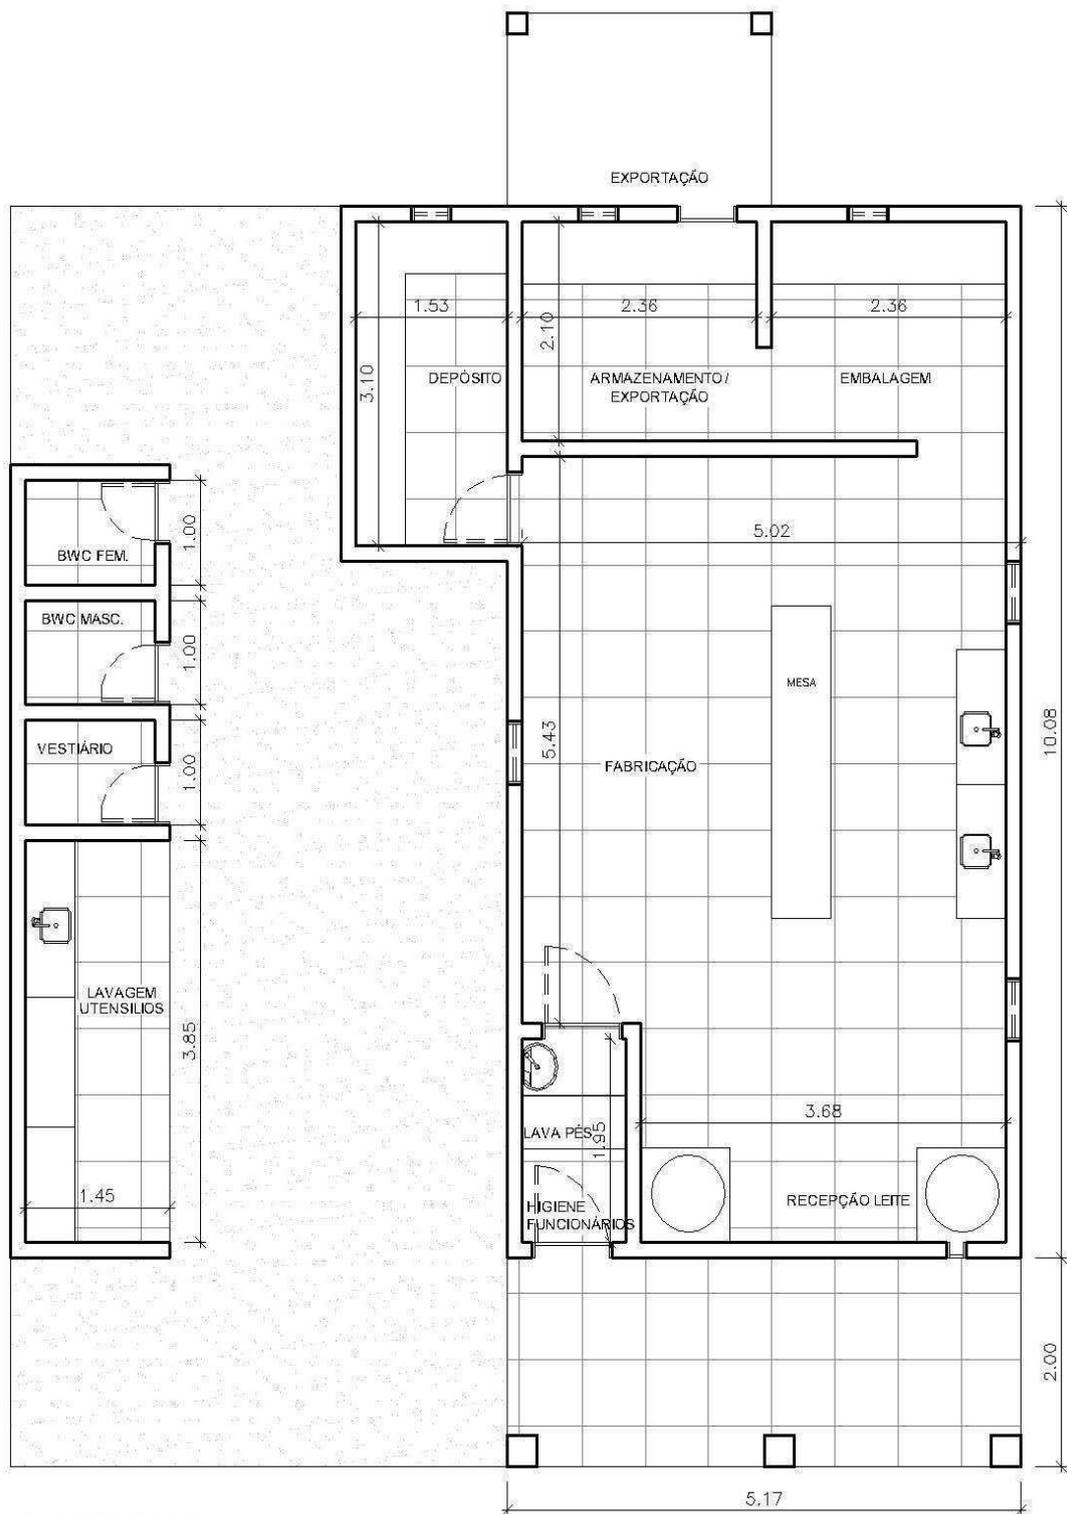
Planta baixa Queijaria C. Fonte: Autora, 2021.
